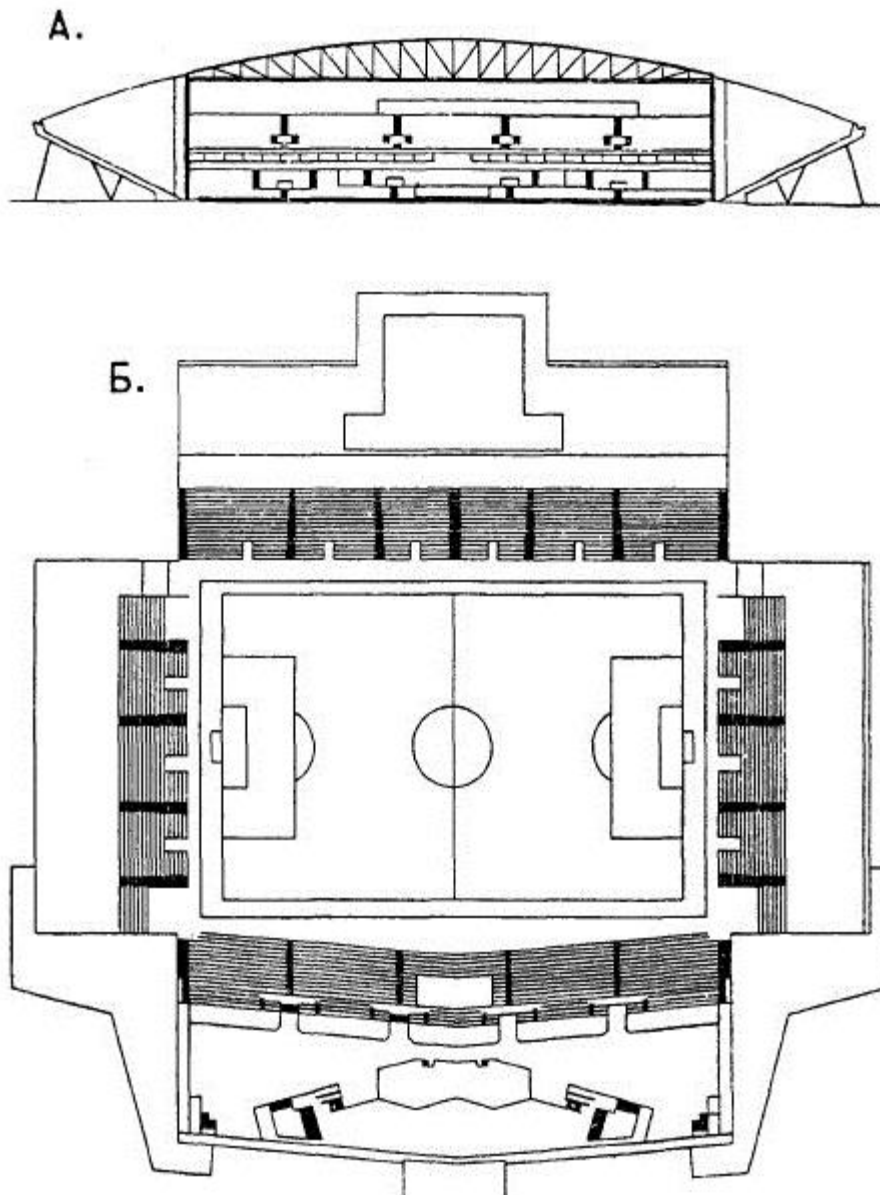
Стадіон «Євродром» у м. Арнгейм (Голландія): А – поздовжній розріз, Б – план першого поверху на рівні входу
